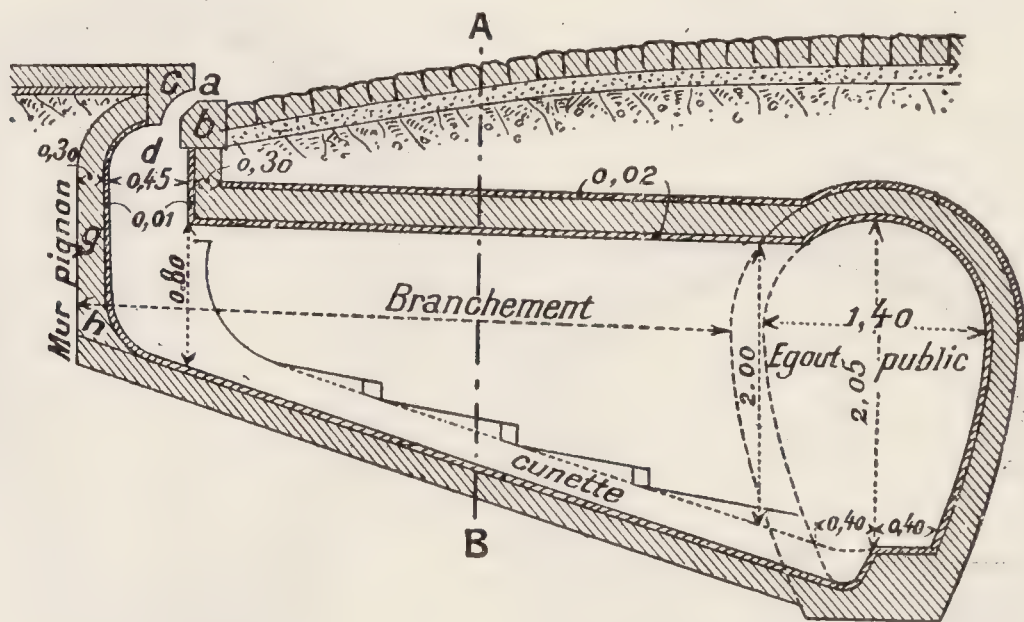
Bouche d'égout et branchement d'après Imbeaux).
